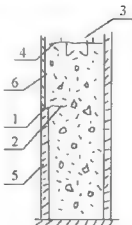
柱身混凝土水平沉落阻滞裂缝
